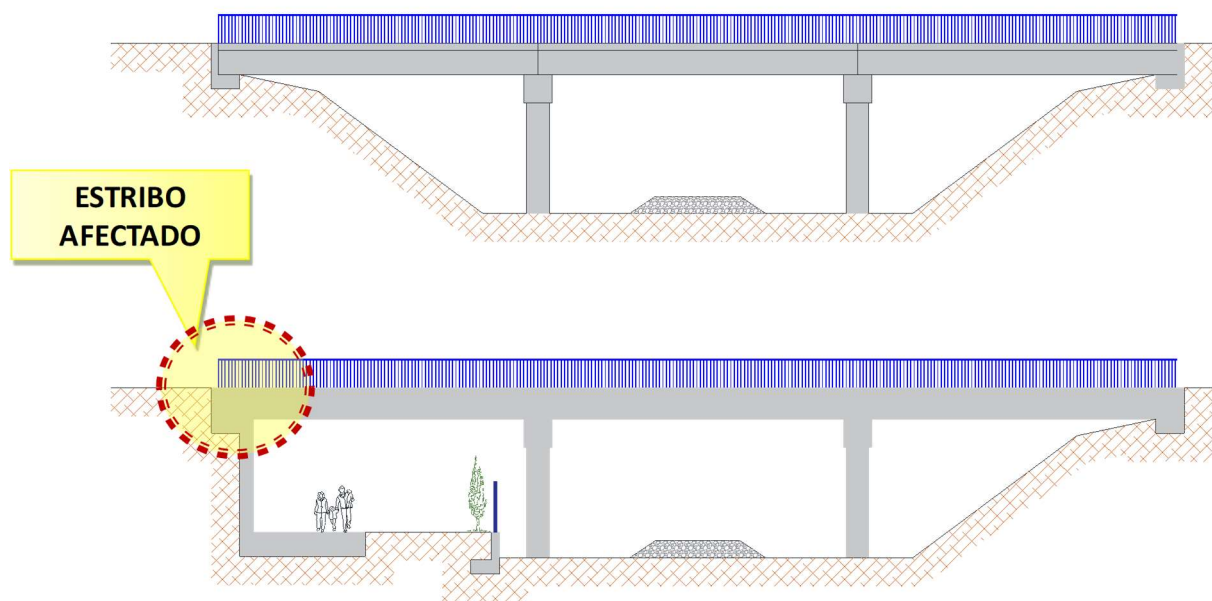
Croquis de la solución planteada. Fuente: propia
